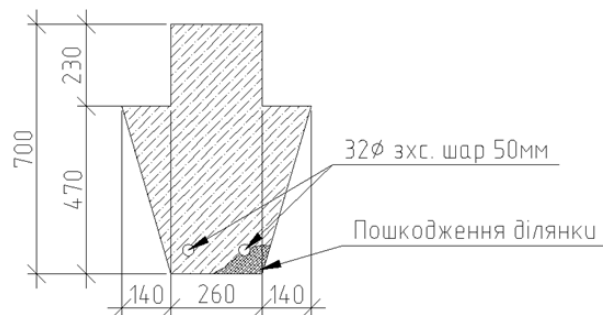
Поперечний переріз збірного залізобетонного ригеля перекриття
